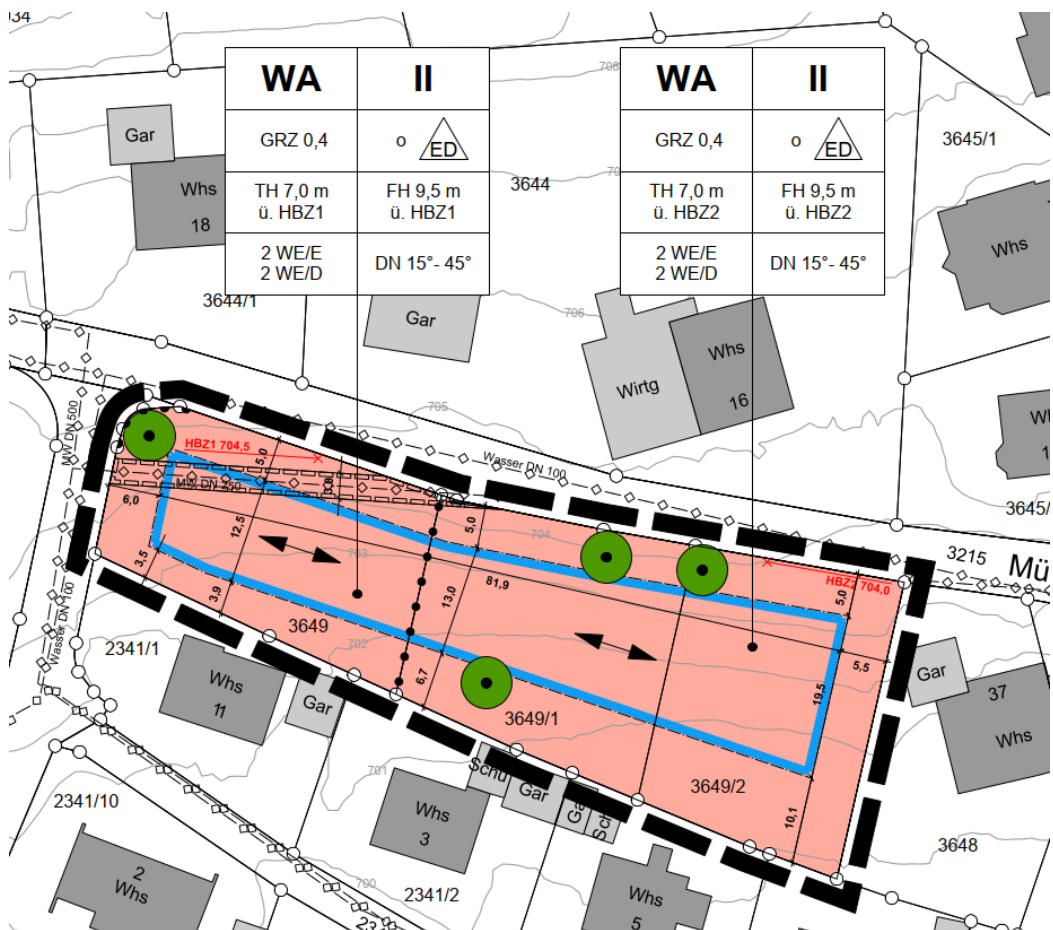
BPlan „Gewann Weiherfeld – Änderung Flst. Nrn. 3649, 3649/1, 3649/2“, Quelle: planwerk-schauer, 23.03.2026
